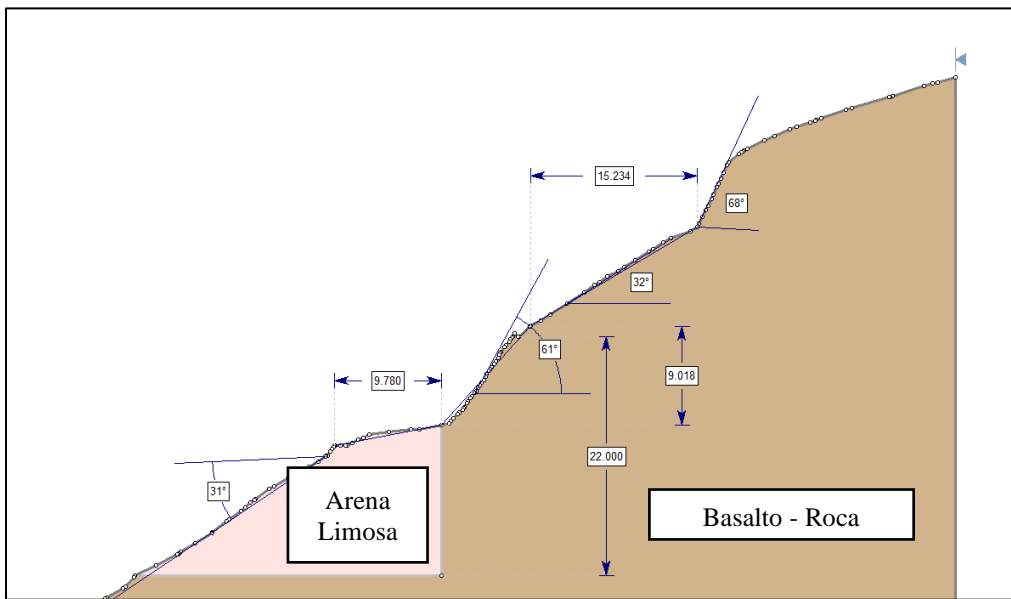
Tramo 2: Sección en PK 2+200 (Dimensiones en metros).
